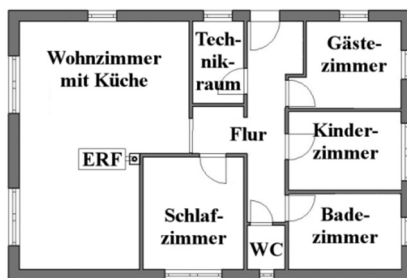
Grundriss des EFH-Bungalows
